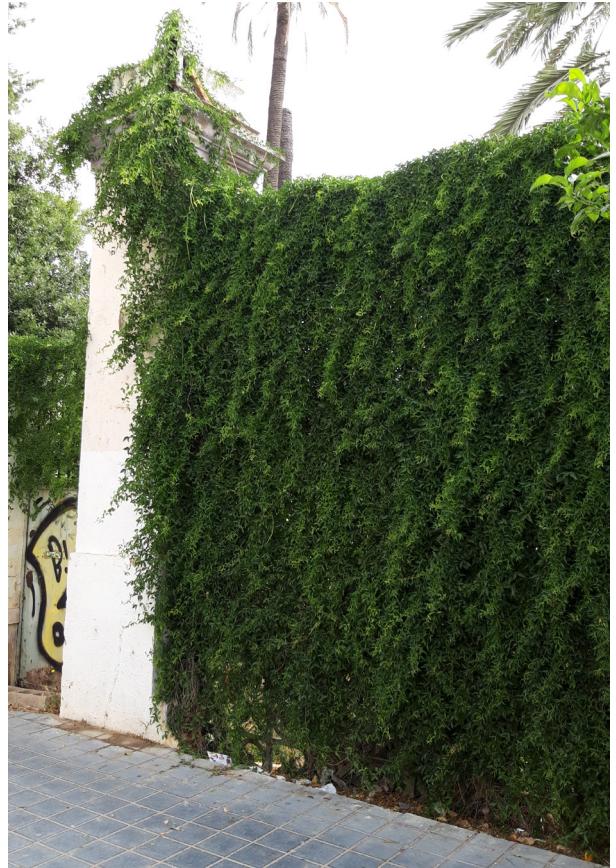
Puerta de acceso totalmente cubierta por una planta trepadora. Fuente: fotografía propia
